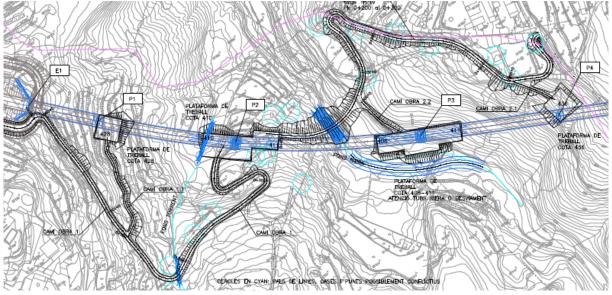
Plano de caminos y plataformas de trabajo provisionales de obra, incluye desvío del torrente.
